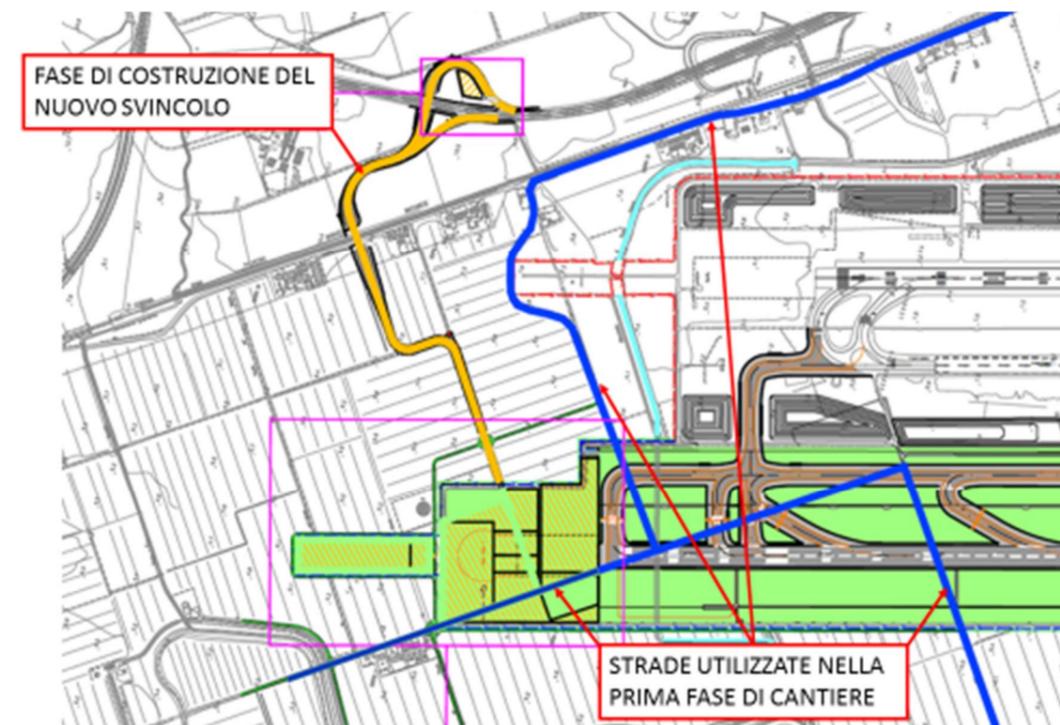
Planimetria della viabilità nelle prime fasi di cantiere
